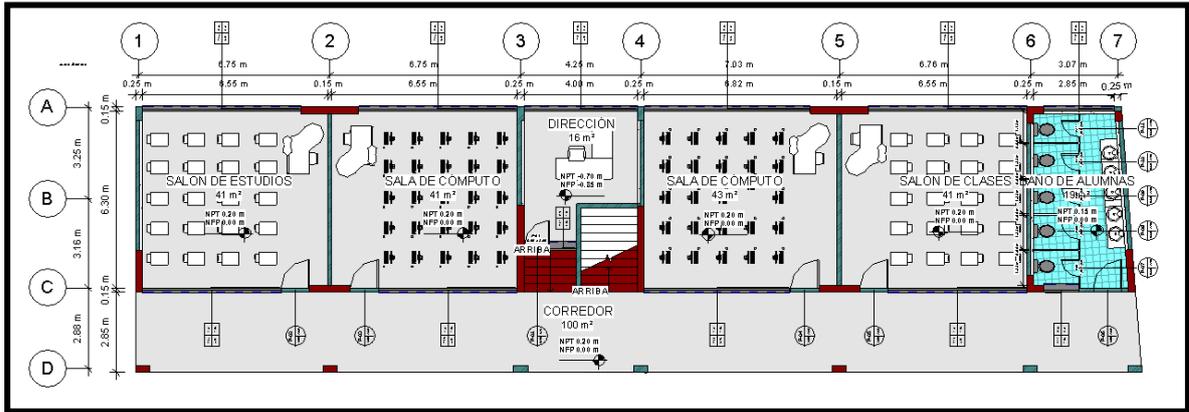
Plano de arquitectura de la primera planta del centro educativo.
